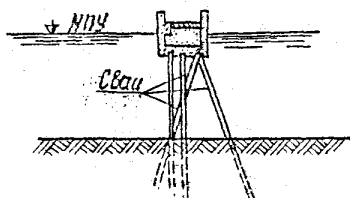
Незасыпные конструкции причальных и направляющих сооружений:
